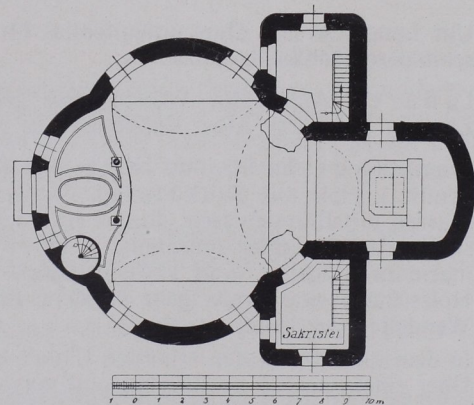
Bruneck, Kapelle, Grundriß 1:300 (S. 211).
